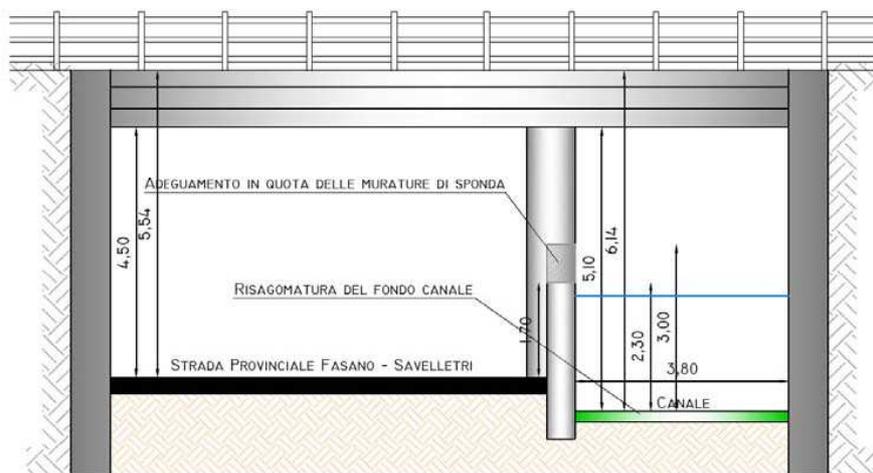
Sezione dell'attraversamento alla linea ferroviaria Bari-Lecce.
